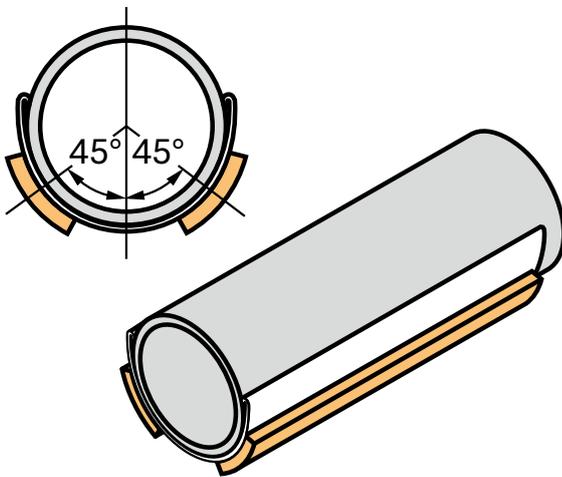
Exemple d'une pose avec chauffage secondaire
